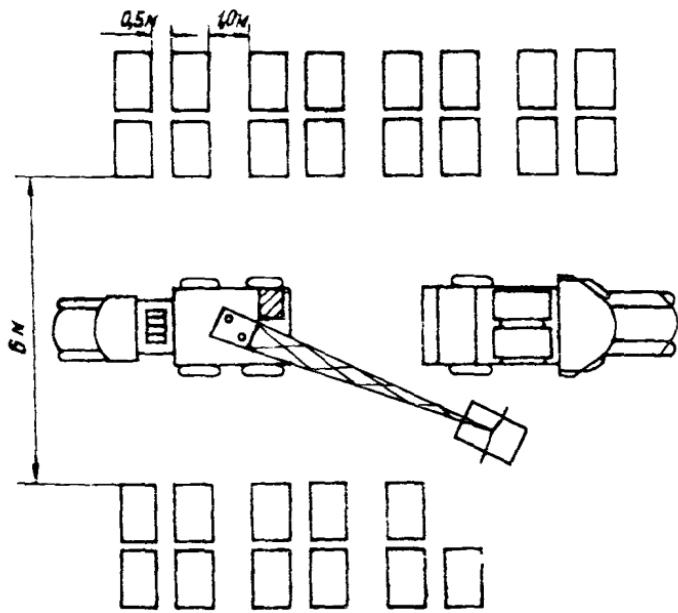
Размещение барабанов с кабелем на кабельной площадке
